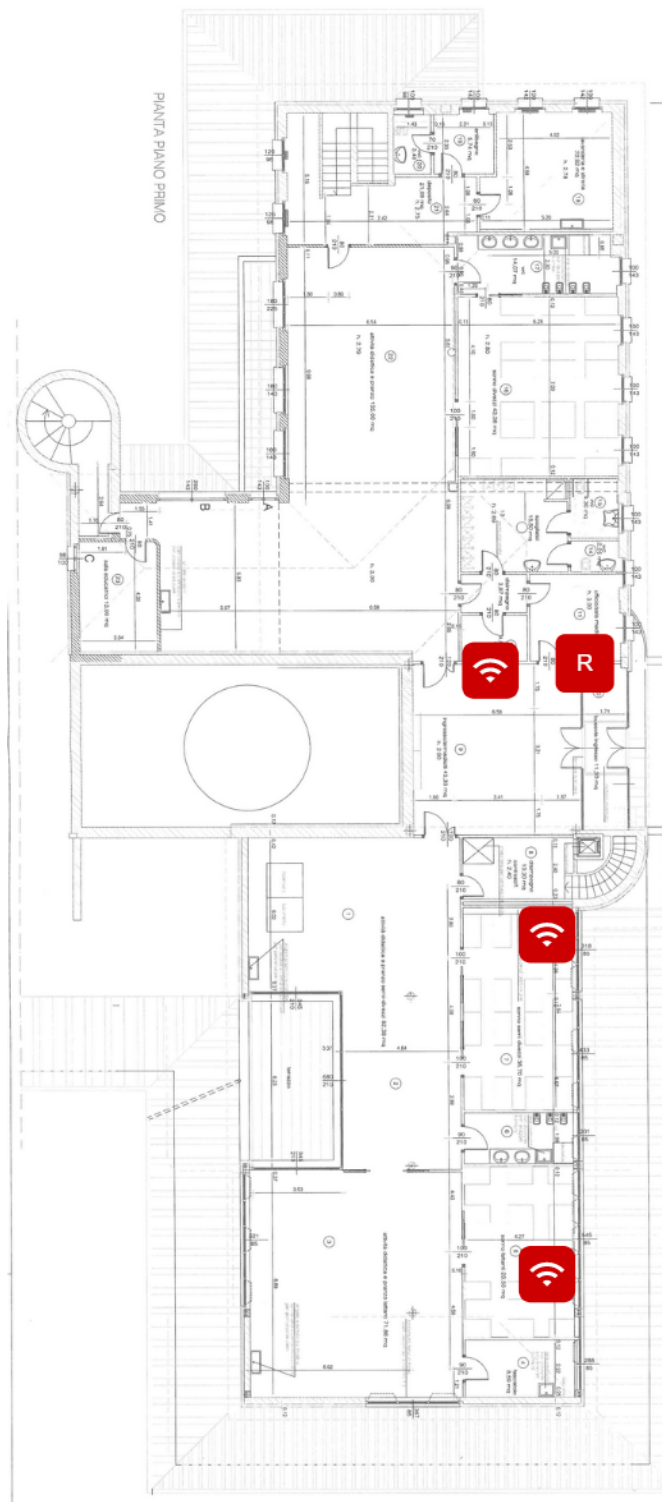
Planimetria Scuola dell'Infanzia "A. & M. Roncoroni" - Piano primo
